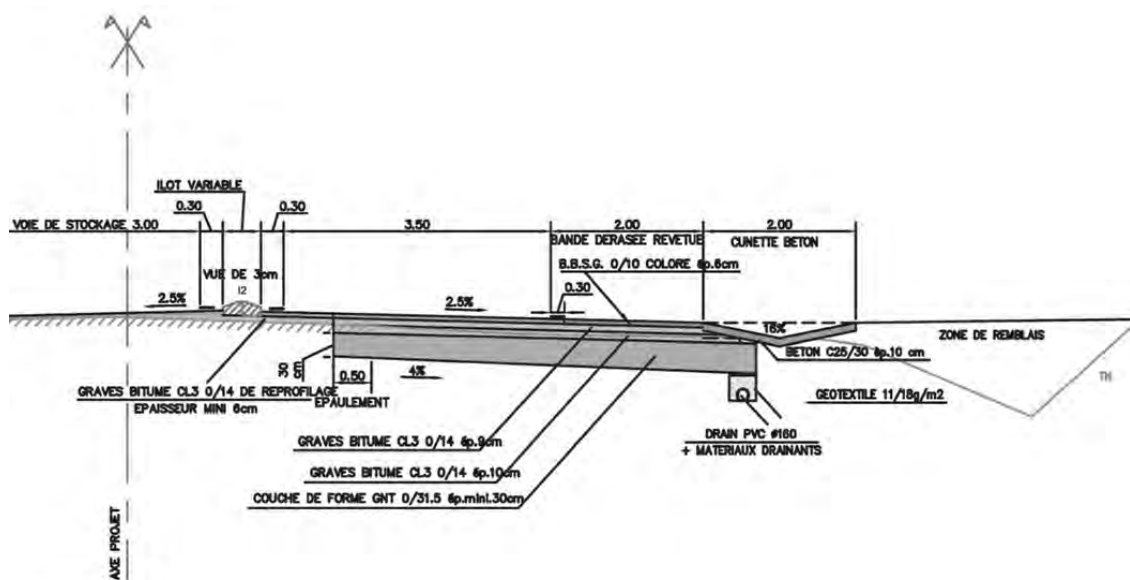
Carrefour plan ordinaire – Profil en travers type. (Voir cahier couleur p.100-101)
